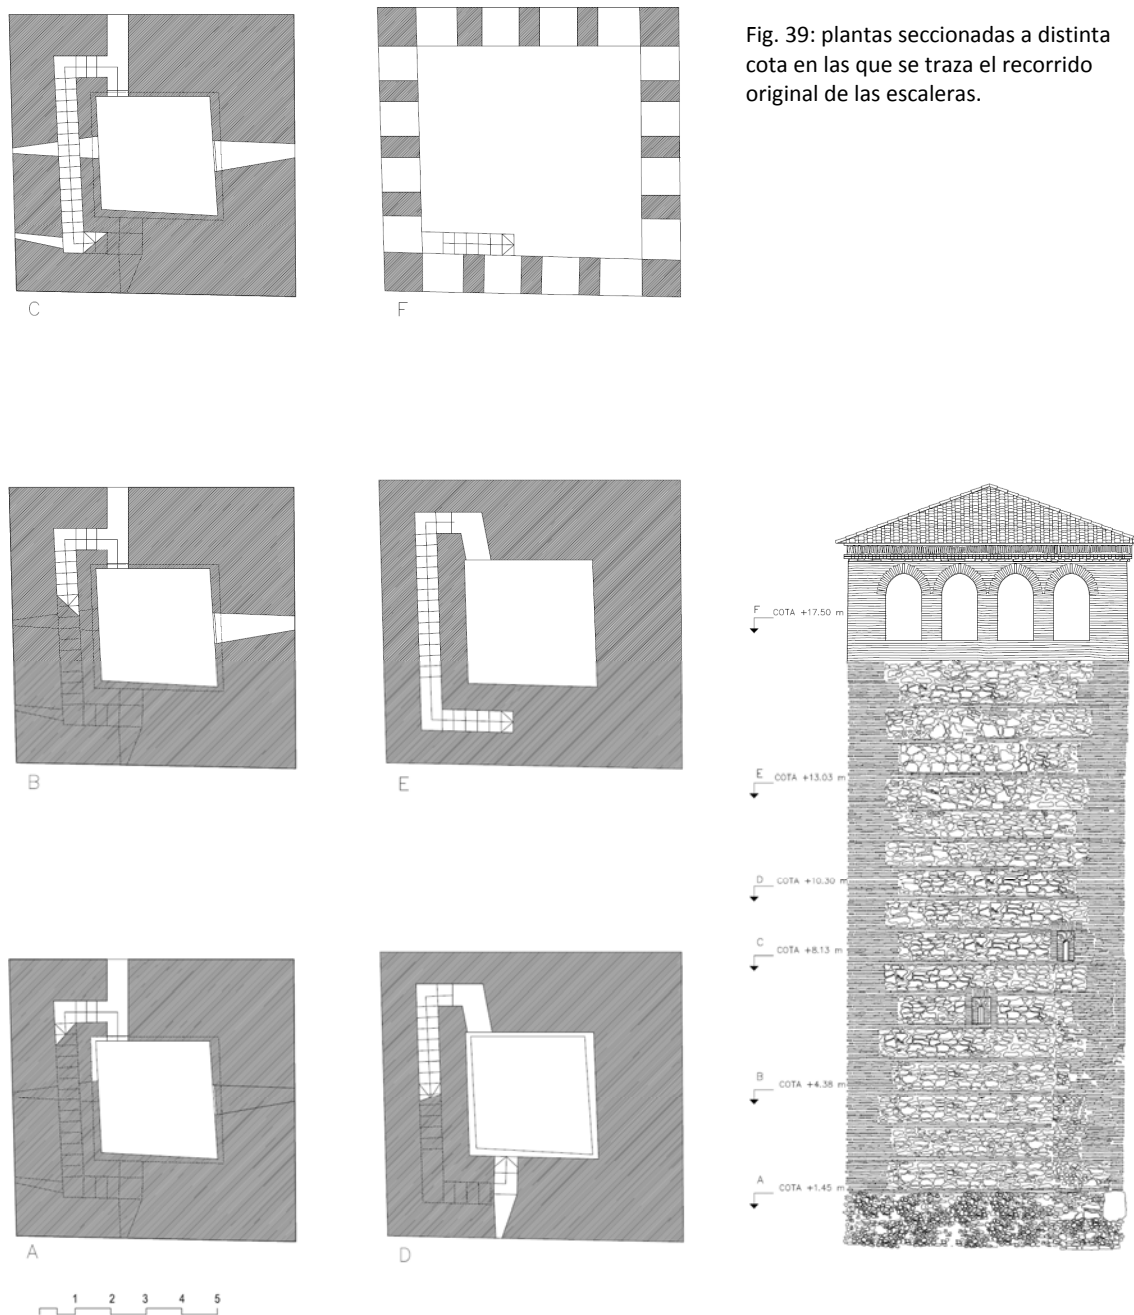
plantas seccionadas a distinta cota en las que se traza el recorrido original de las escaleras.
